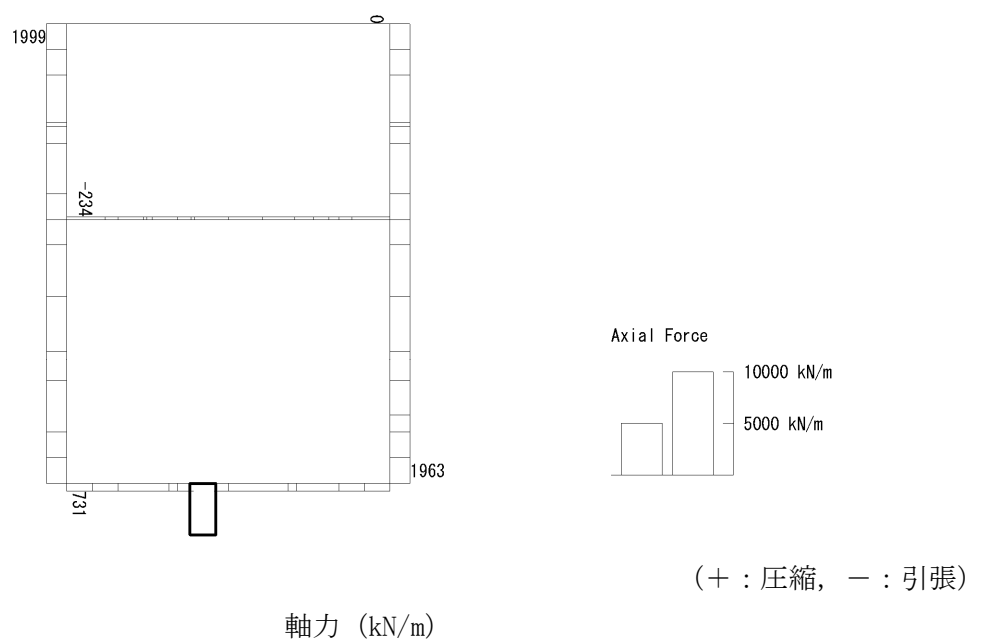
(13) 東側壁 B1F (開口部) コンクリートの曲げ軸力照査に用いる断面力図
